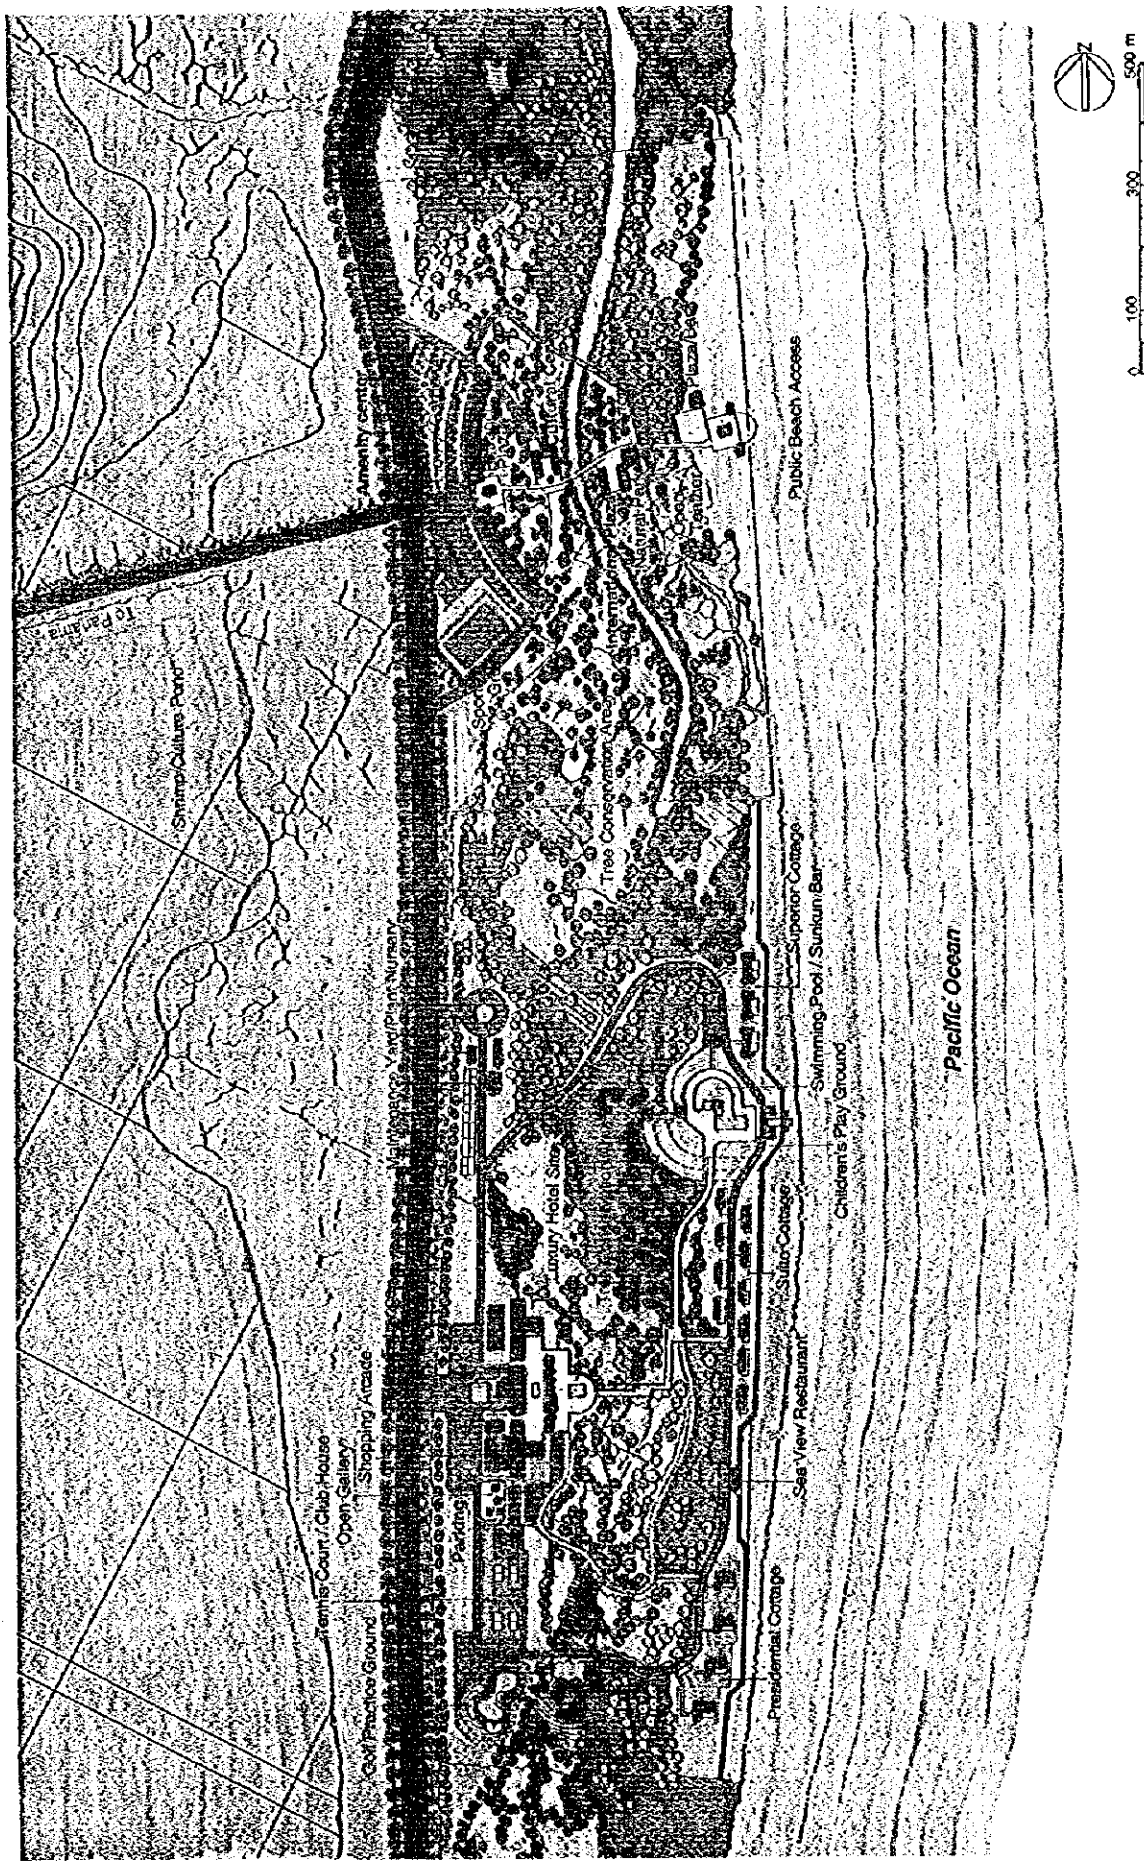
Plan de Desarrollo del Área Central de Chame (Centro de Recreación y Complejo Hotelero)
